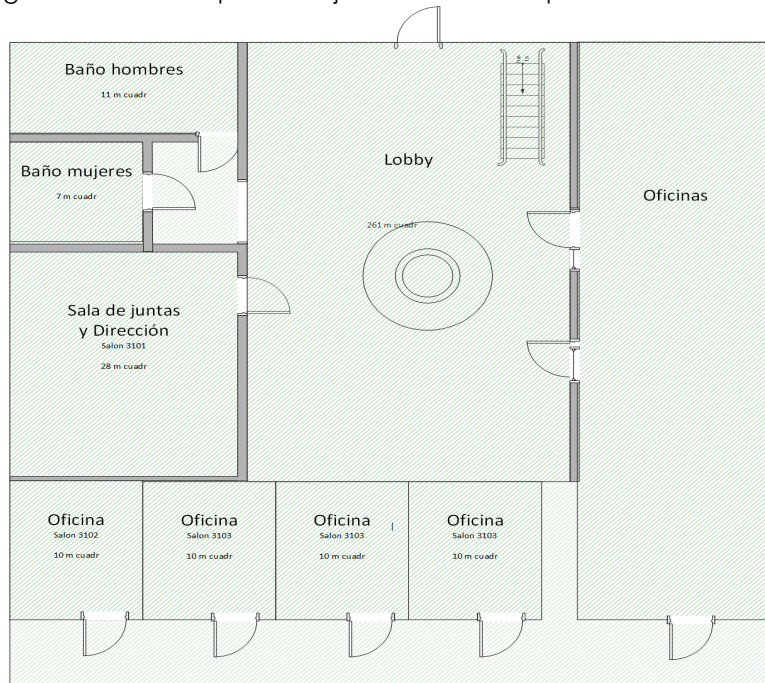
Planos de planta alta edificio de computación en Cenidet.
